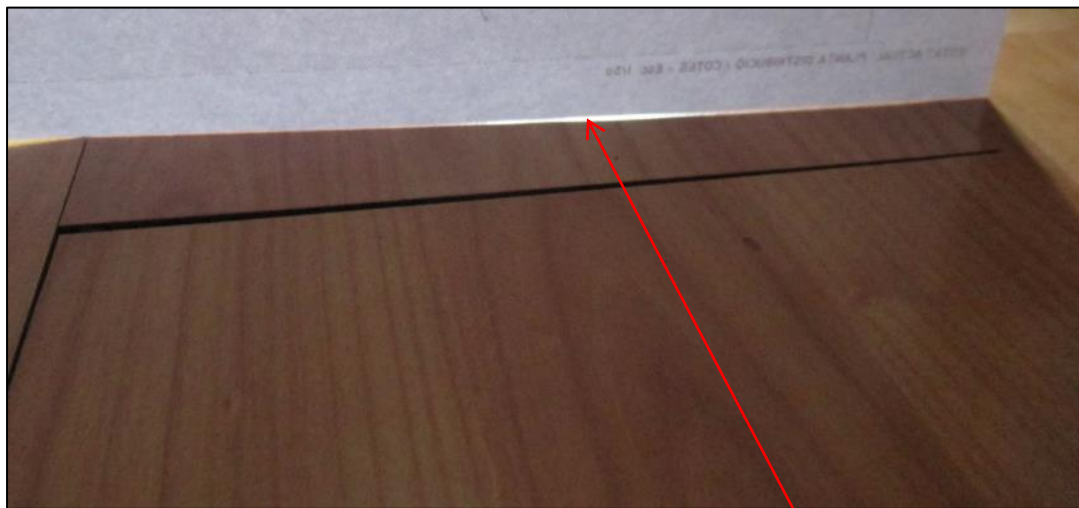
Efectos de la curvatura de las piezas de pavimento flotante.
